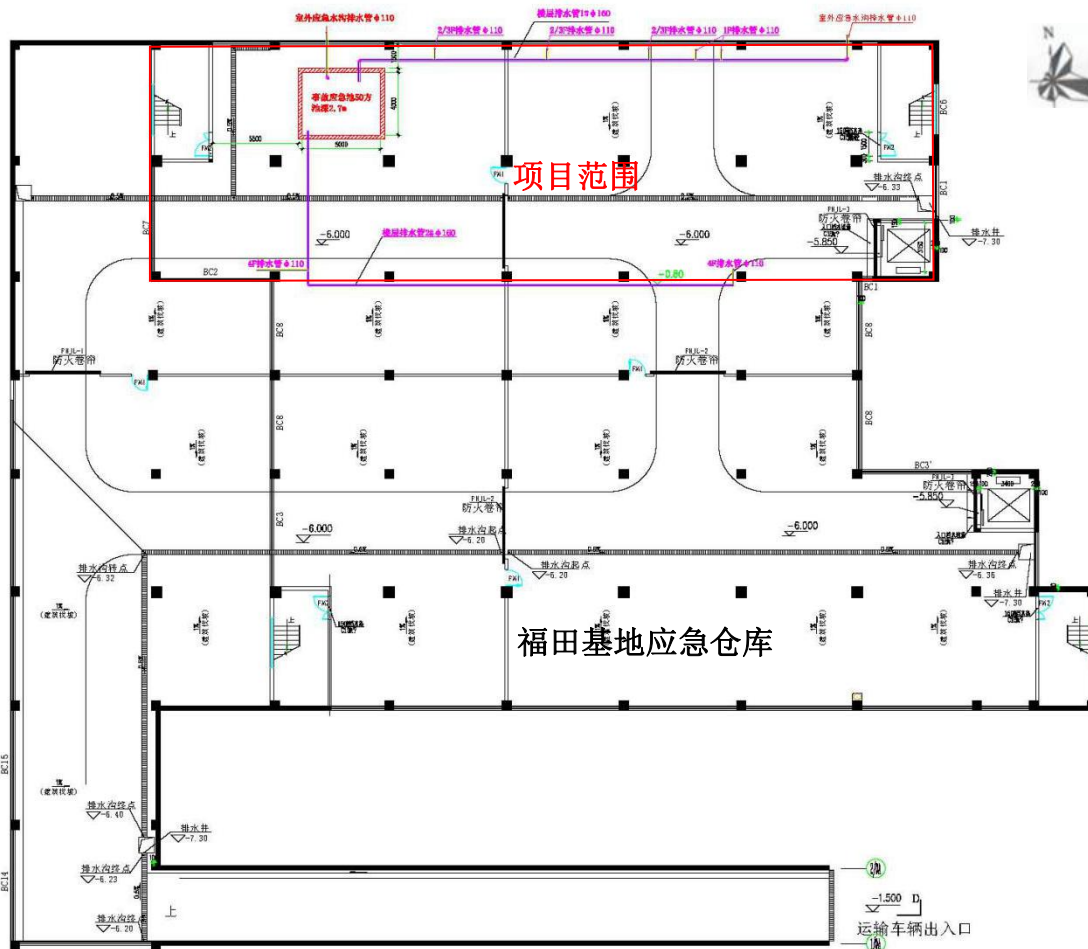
危险废物收集与转运中心地下负一层平面图（部分在项目范围内）
